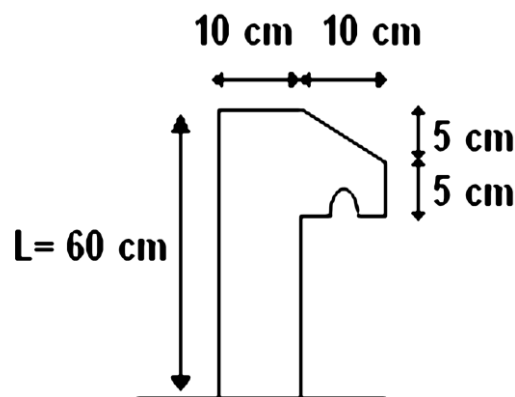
COUPE TRANSVERSALE DE L'ACROTÈRE
